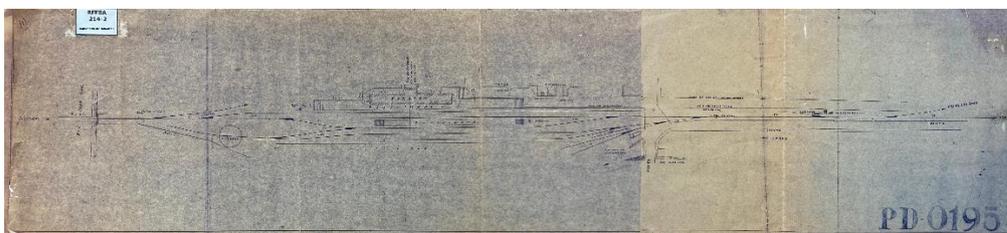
Item 214-2 do Arquivo da RFFSA, datado de 02/05/1957. Planta de situação da Esplanada de Jaboatão. (Fonte: Foto da autora do material disponível para consulta presencial no acervo do IPHAN-PE)
